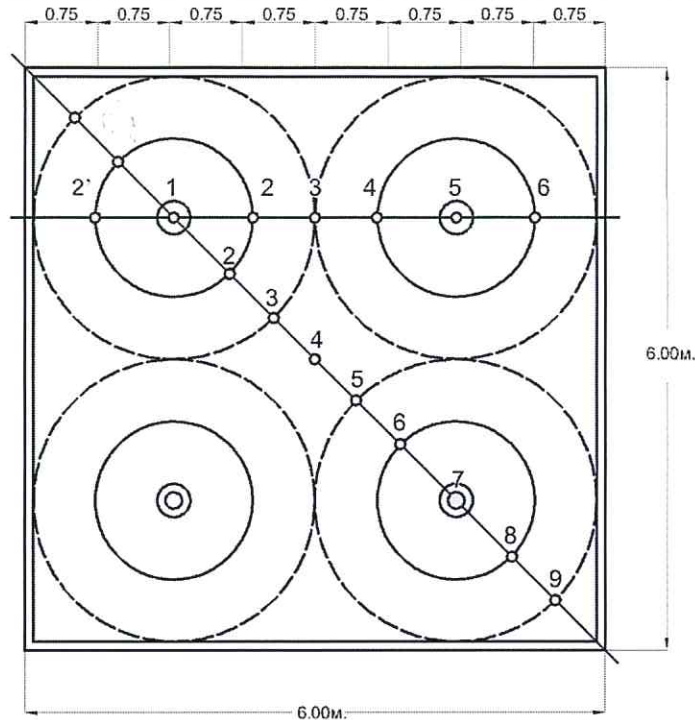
Размещение трубчатых световодов естественного света на плане помещения (с изолиниями КЕО от каждого световода)
